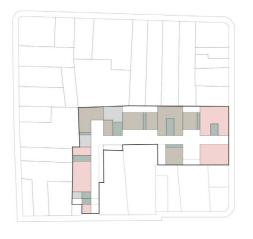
Zonificación Planta Baja Fuente: Autores, 2022
